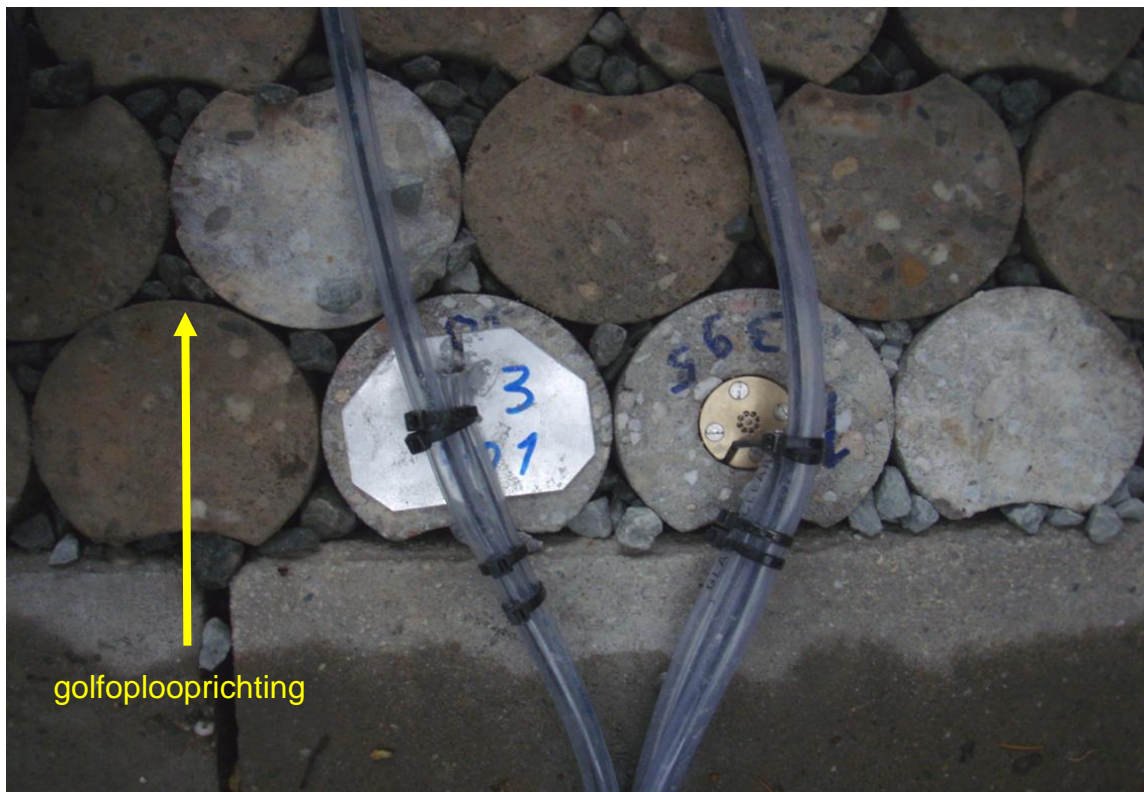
Modelopstelling (detail bovenaanzicht DRO's in testsectie zuilen)
